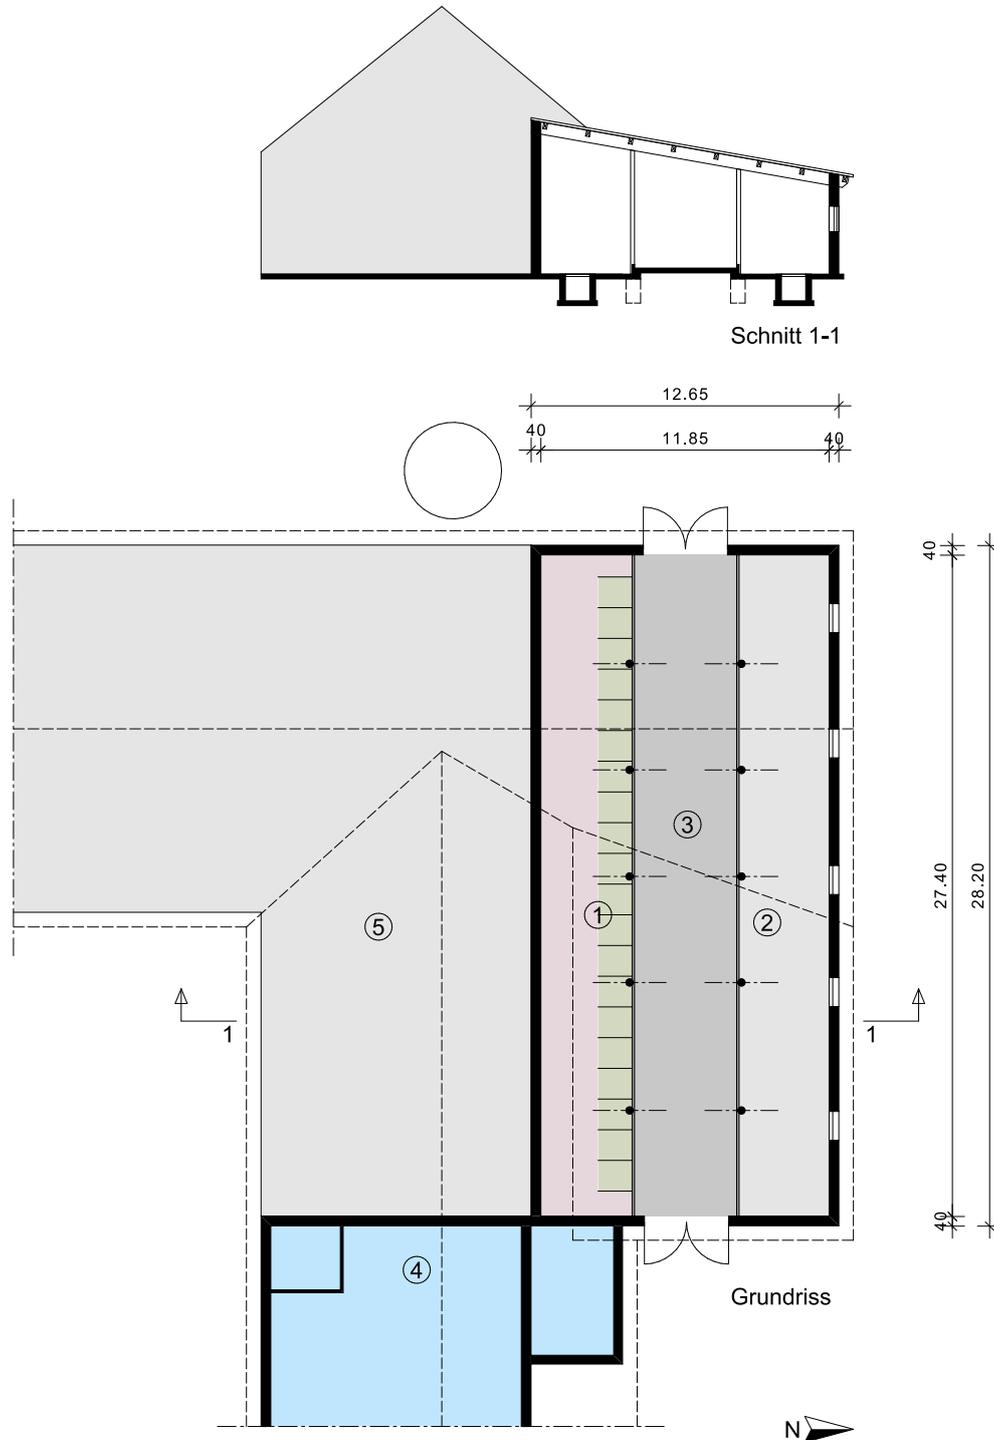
Bauzeichnung Altgebäude Betrieb D
